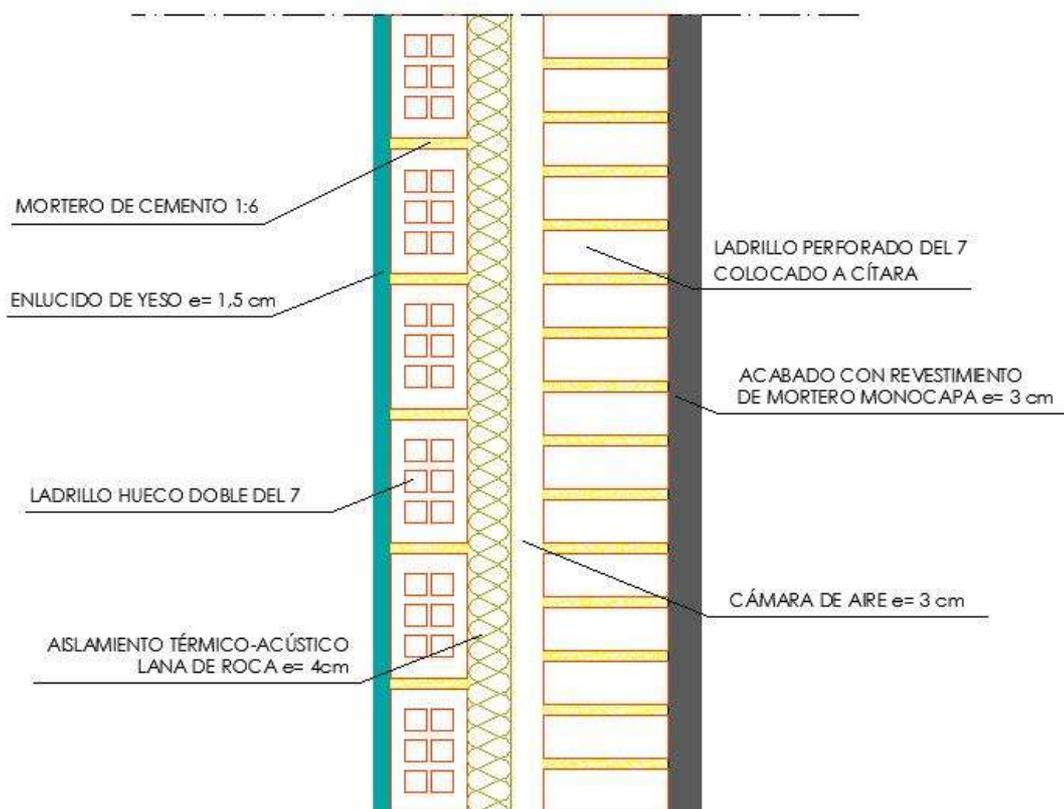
Fachada principal existente – Fuente: Creación propia
